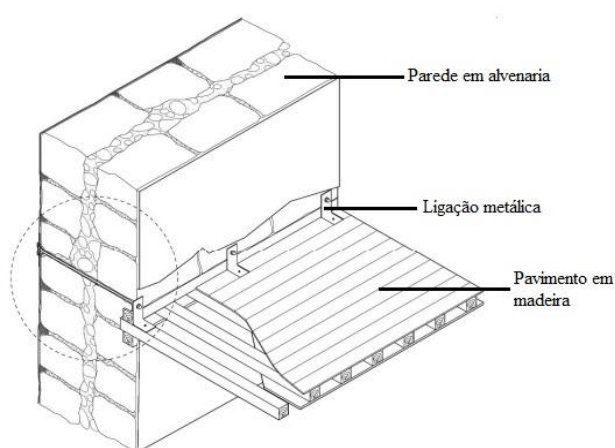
Esquema de utilização de peças metálicas para reforço da ligação entre paredes e pavimentos [Cóias, 2007]
